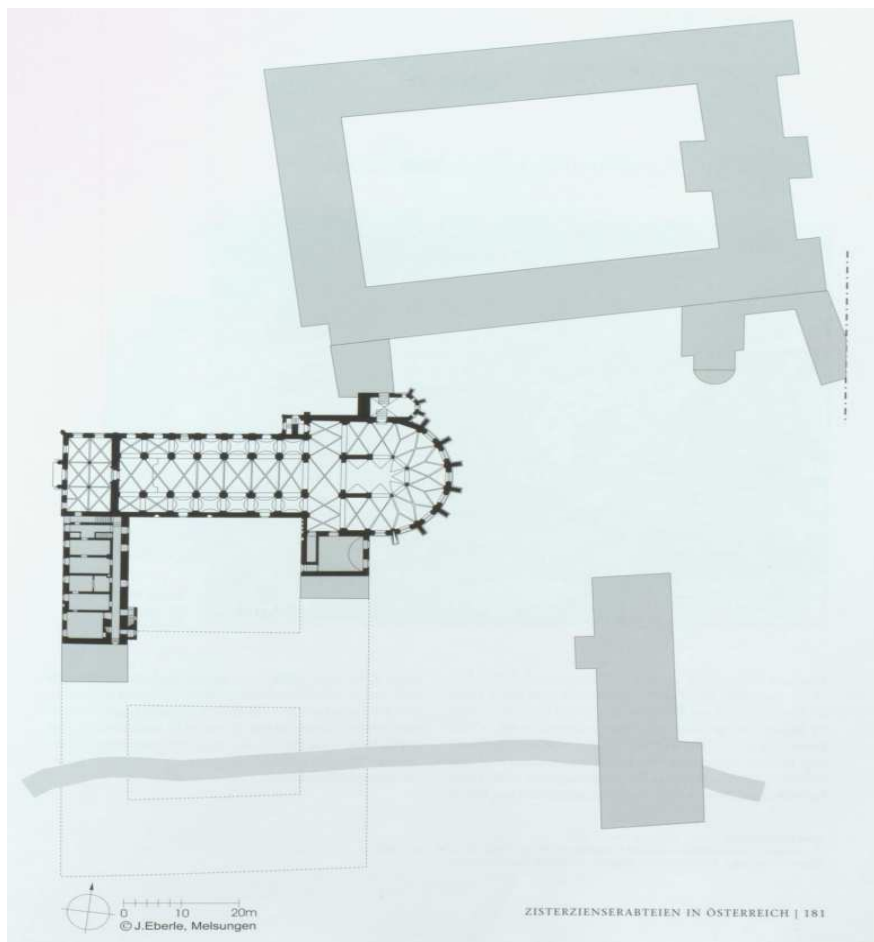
Stift Baumgartenberg, Grundriss Jürgen Eberle
